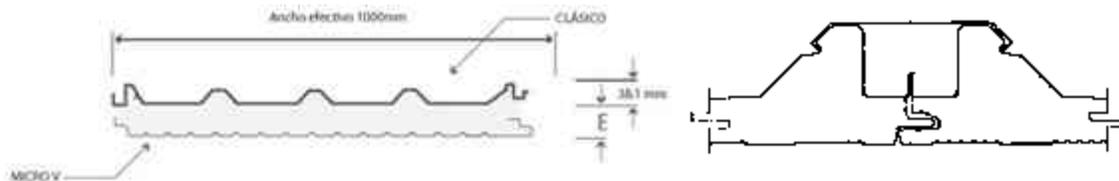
En la imagen superior izquierda se aprecia un detalle constructivo de la sección transversal de prefabricado Multytecho; en la imagen superior derecha se aprecia un detalle de unión de panel con panel por medio de un ensamblaje sencillo por un elemento macho y otro hembra que penetran y se unen, la ceja posterior cubre la junta evitando filtraciones de agua. Imágenes obtenidas en: <http://www.panelaislado.com>
